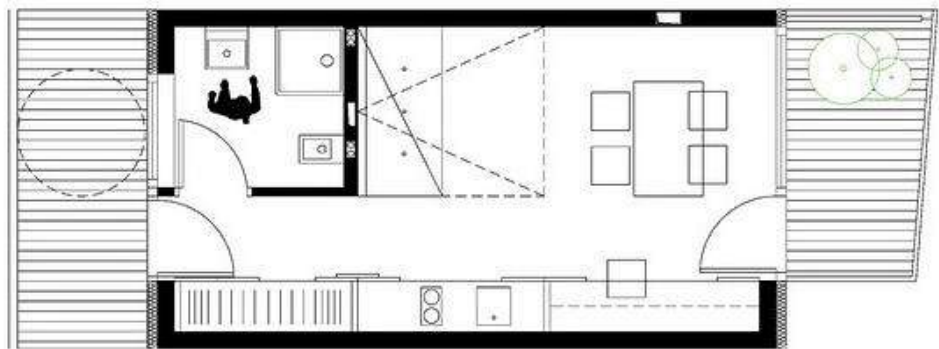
Einzelzimmer Grundriss Basket Apartments
